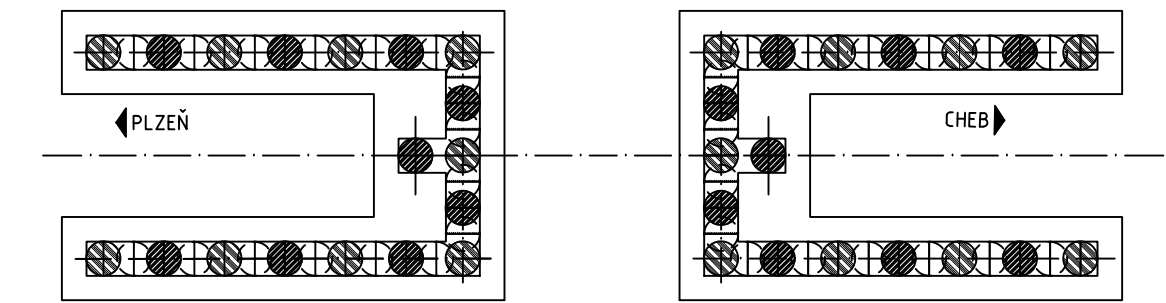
DETAIL PŘEBETONOVÁNÍ HLAV PILOT
